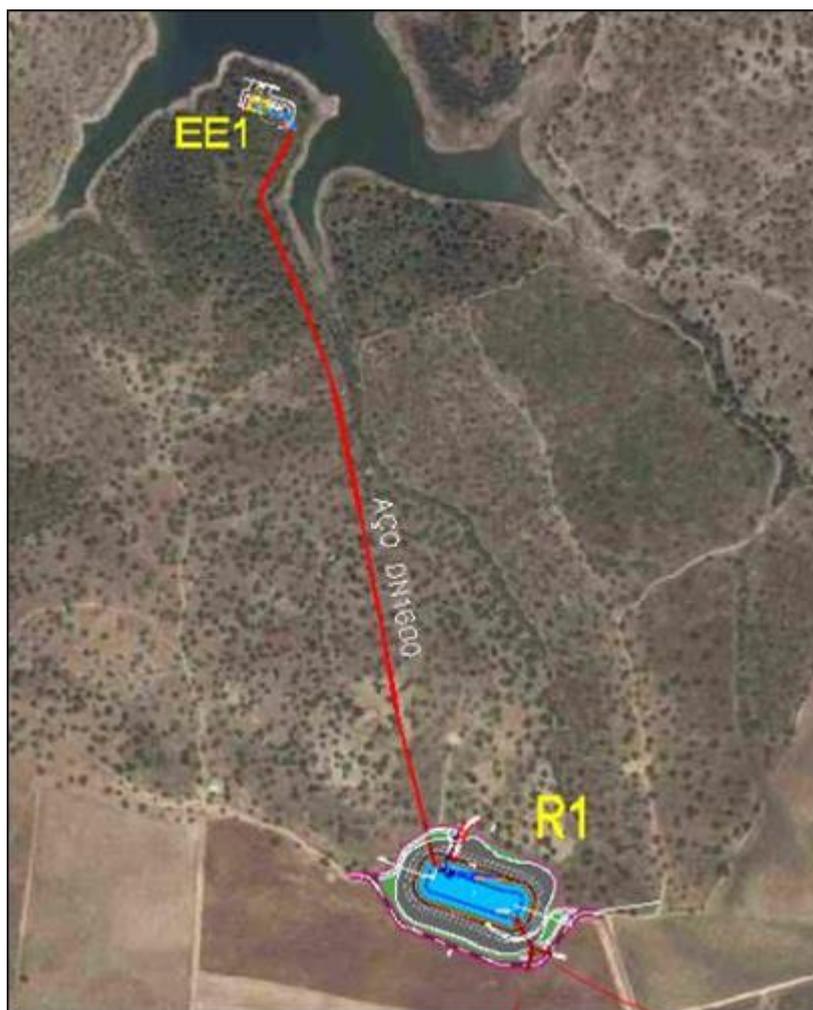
Implantação da conduta elevatória CE1 (EE1-R1)
